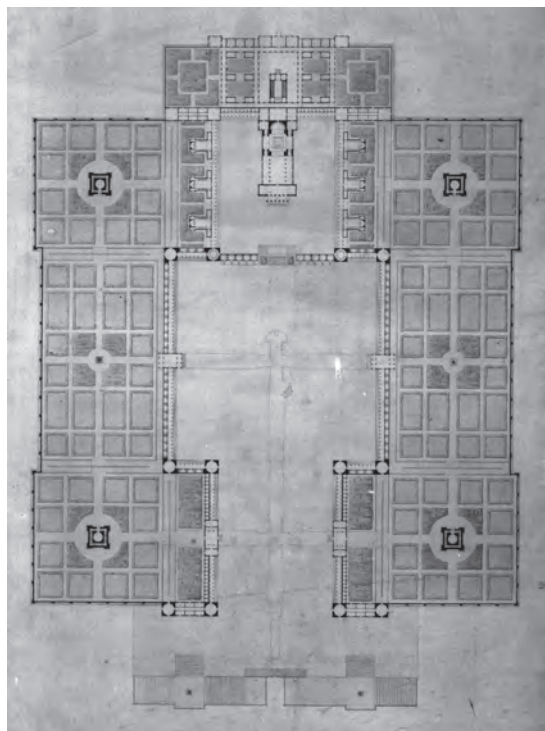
Pianta (Archivio Giuseppe Damiani Almeyda di Palermo).
